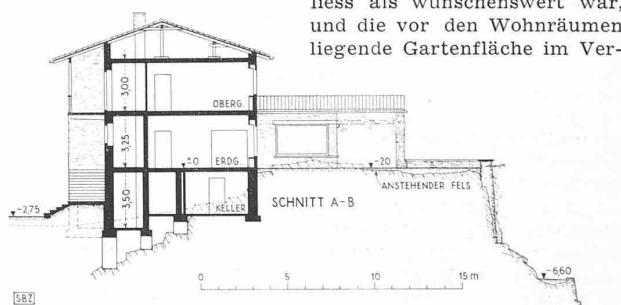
und 6. Grundrisse und Schnitt A-B, 1:400, der Casa San Giorgio ob Ascona. — Arch. SCHERRER & MEYER, Schaffhausen
